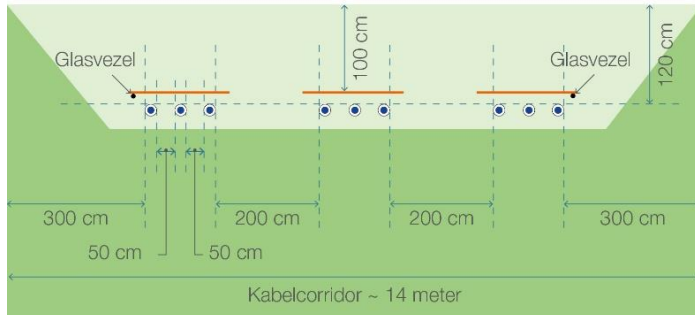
Ruimtebeslag en werkstrookbreedte bij open ontgraving bij parallellegging, waarbij de belemmerende strook 9,8 meter wordt.
